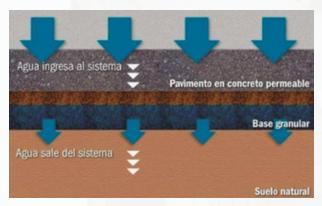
Esquema de estructura típica y funcionamiento de un pavimento de concreto permeable. Arango, S. Concreto permeable: desarrollo urbano de bajo impacto (Acceso marzo 2025).
